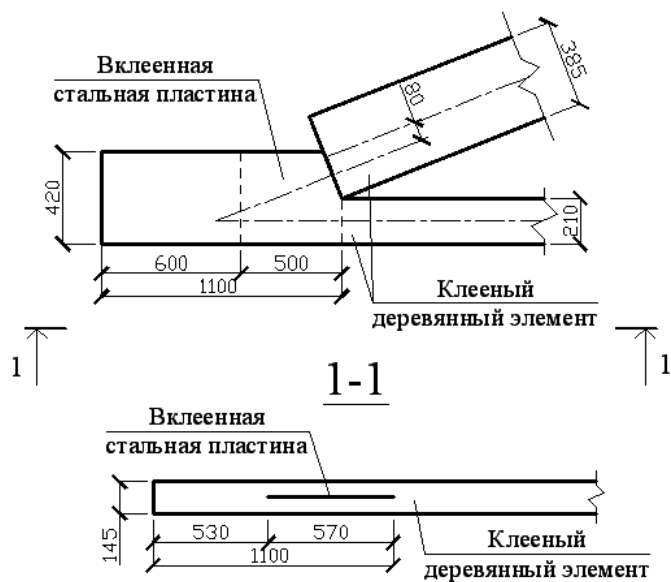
Конструктивное решение опорного узла фермы с вклеенной в нижний пояс стальной пластиной
